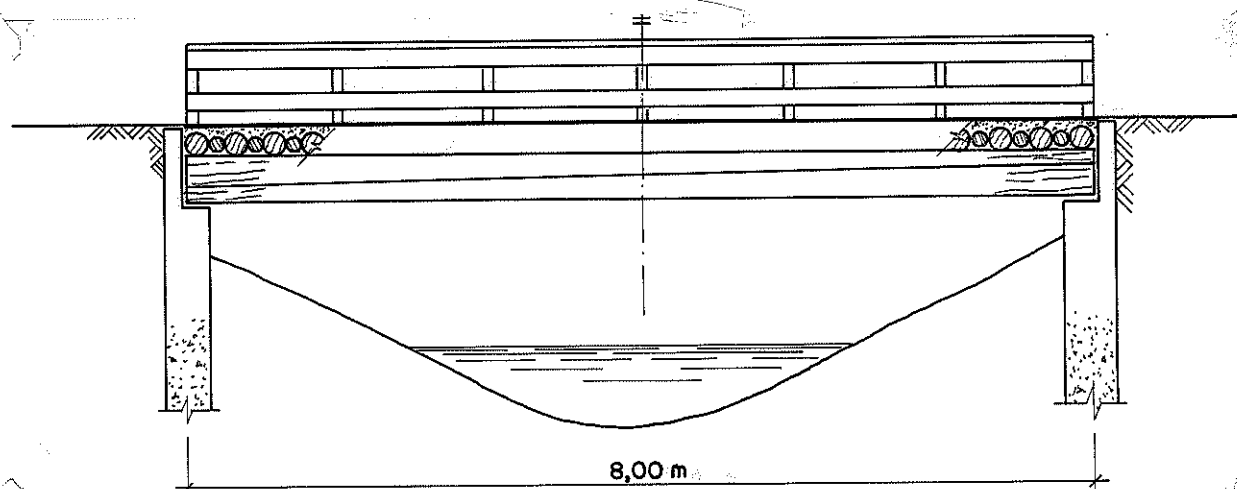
Corte longitudinal da ponte (sem escala)
